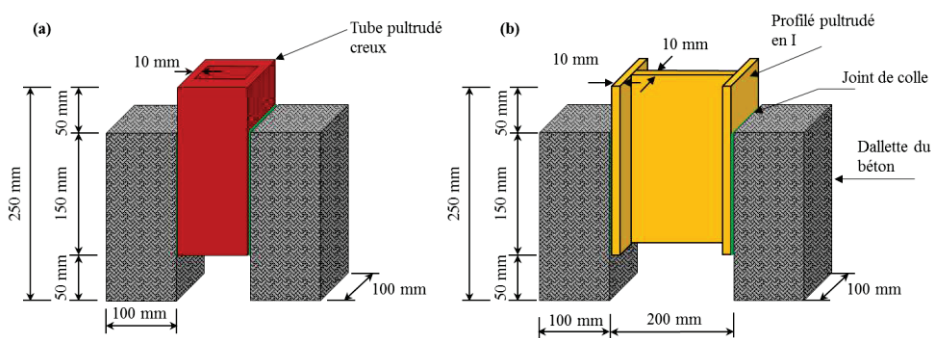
Géométries et dimensions des éprouvettes (a) de la série POCB19 et (b) de la série POCB20
